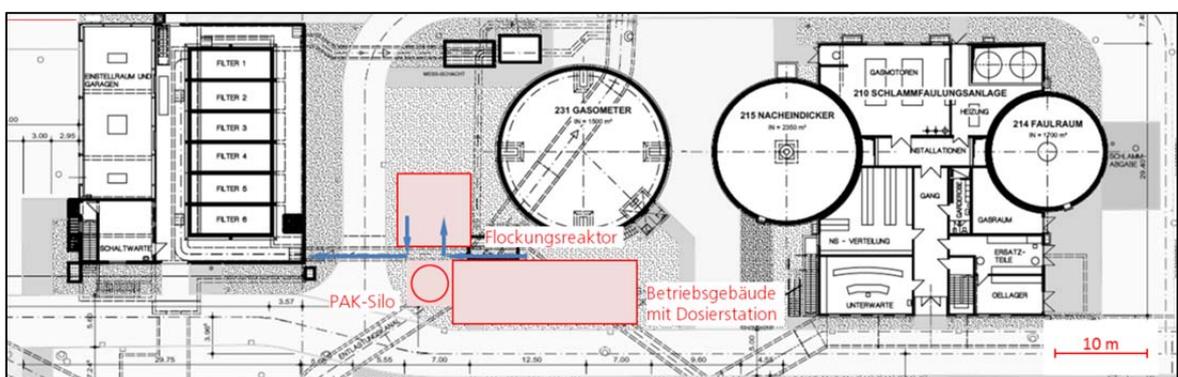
Planskizze Layout PAK-Dosierung auf den Sandfilter
